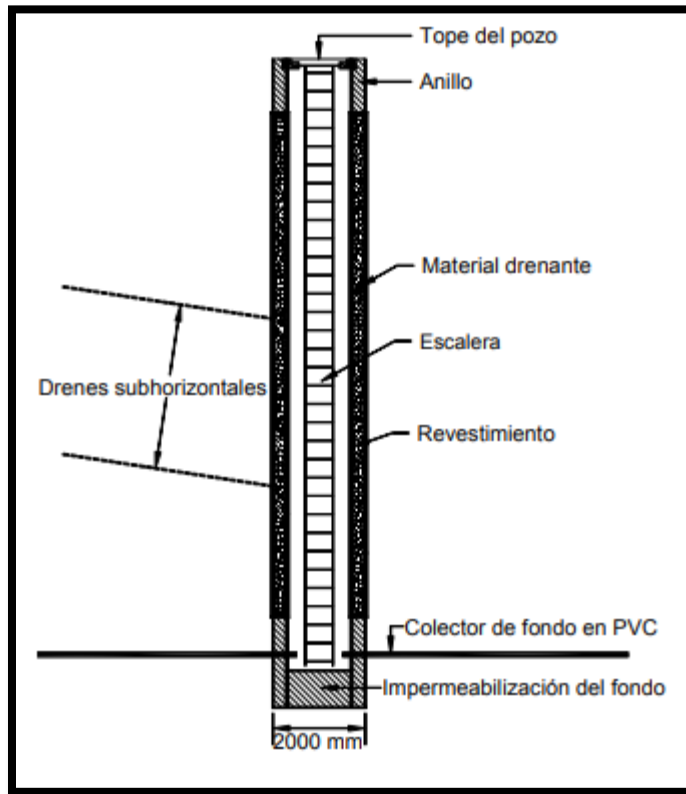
Pozo vertical de drenaje con subdrenes de penetración
